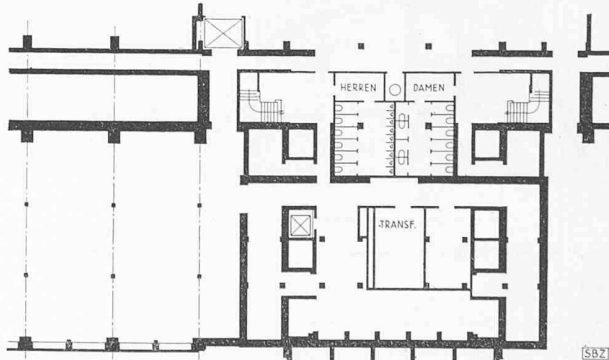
Erdgeschoss 1 : 600 Bild 17 (rechts). Untergeschoss
